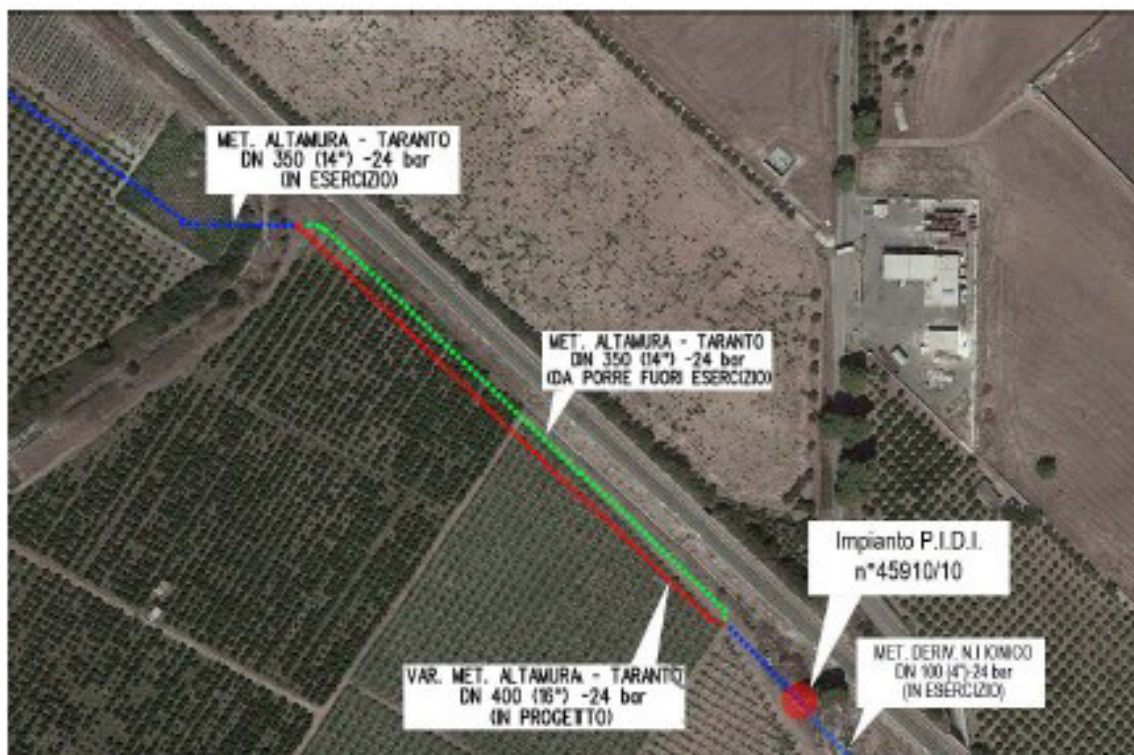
Stralcio ortofoto con localizzazione dell’opera in progetto
